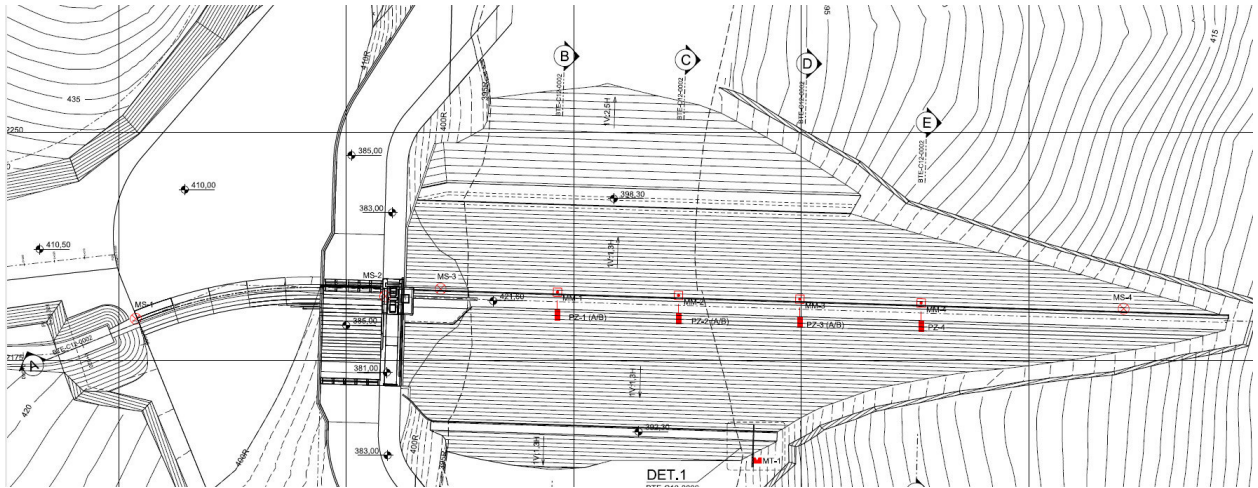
Planta de localização dos instrumentos instalados na Barragem de Enrocamento da Margem esquerda e estruturas de concreto
